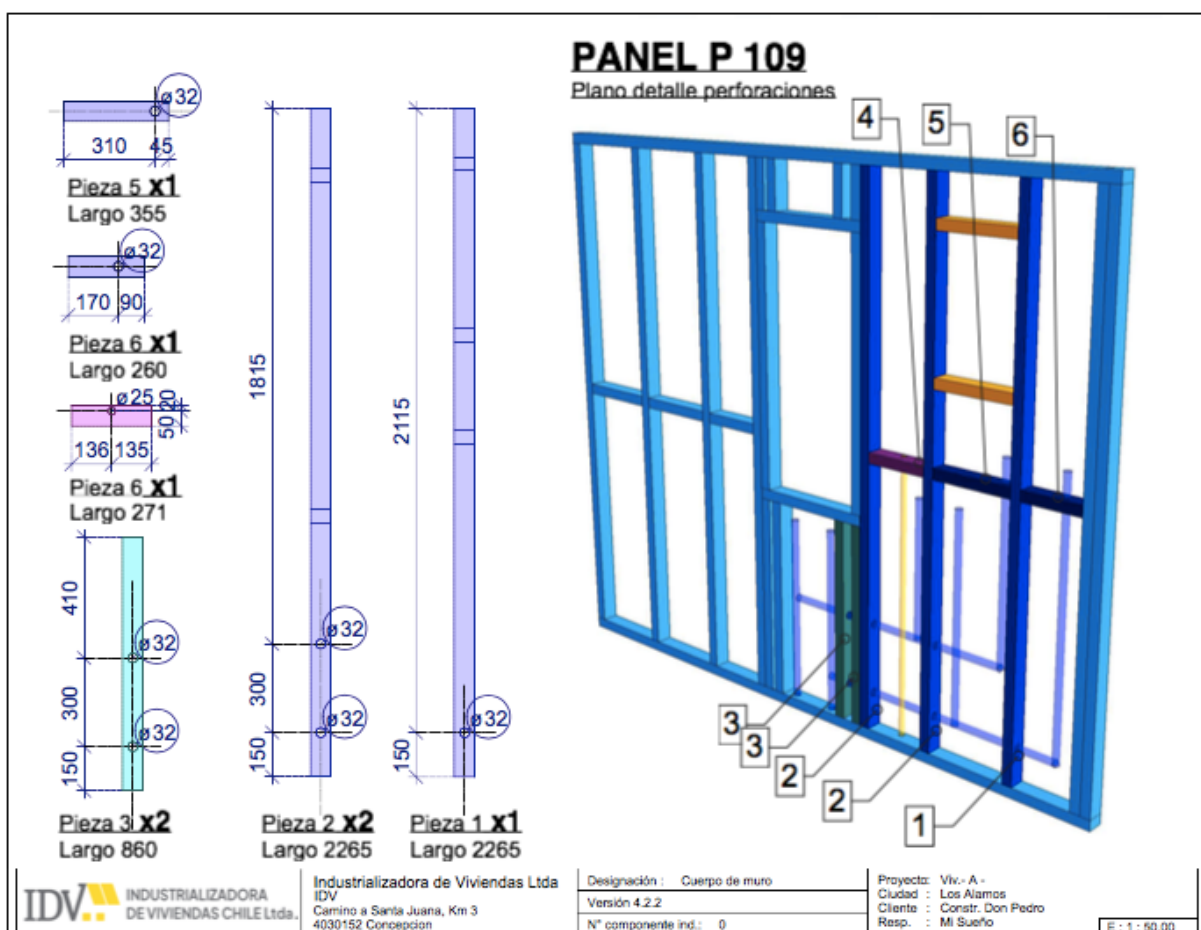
Ejemplo de un plano con detalle de perforaciones.
